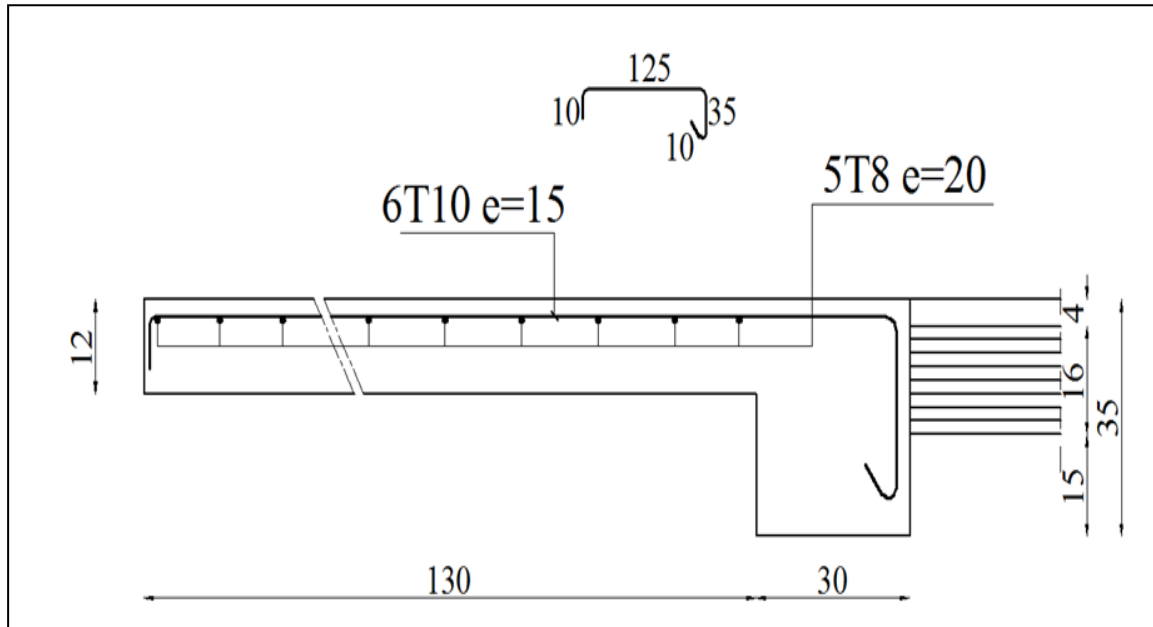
plan de ferrailage du balcon(Étage courant) .
